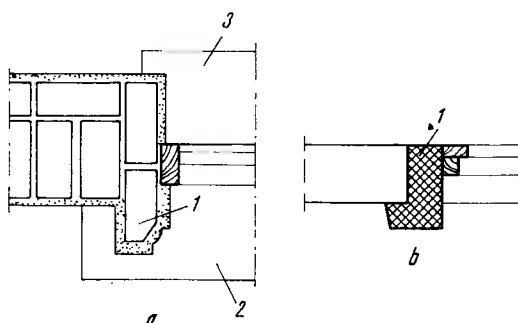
Secțiuni orizontale prin ancadramente: a - din zidărie; b - din beton prefabricat; 1 - montantul ancadramentului; 2 - solbanc; 3 - glaf.
